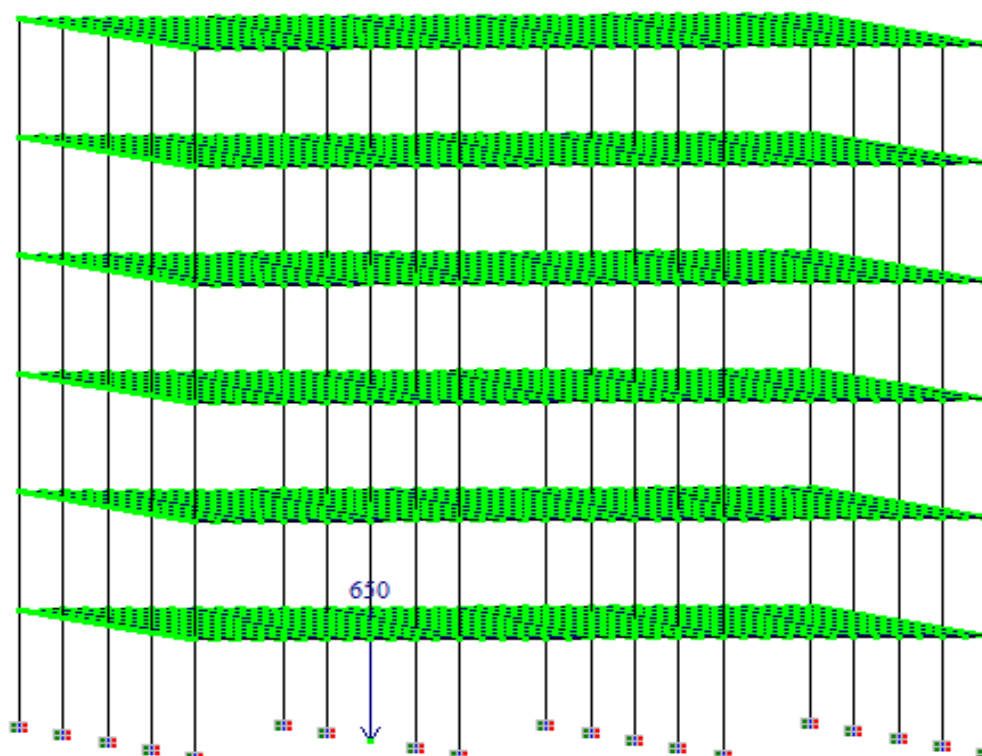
Schéma illustratif du modèle d'étude du bâtiment avec planchers en hourdis à 6 niveaux avec un chargement vertical sur le poteau intermédiaire
